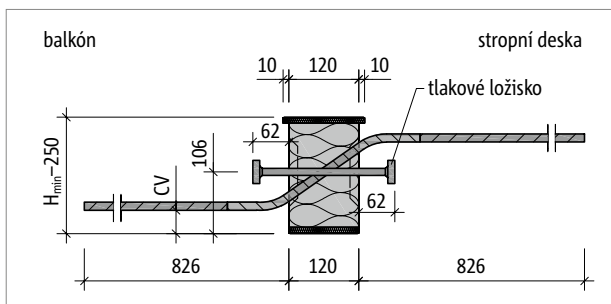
Schöck Isokorb® XT typ QP-V4: Řez prvkem
